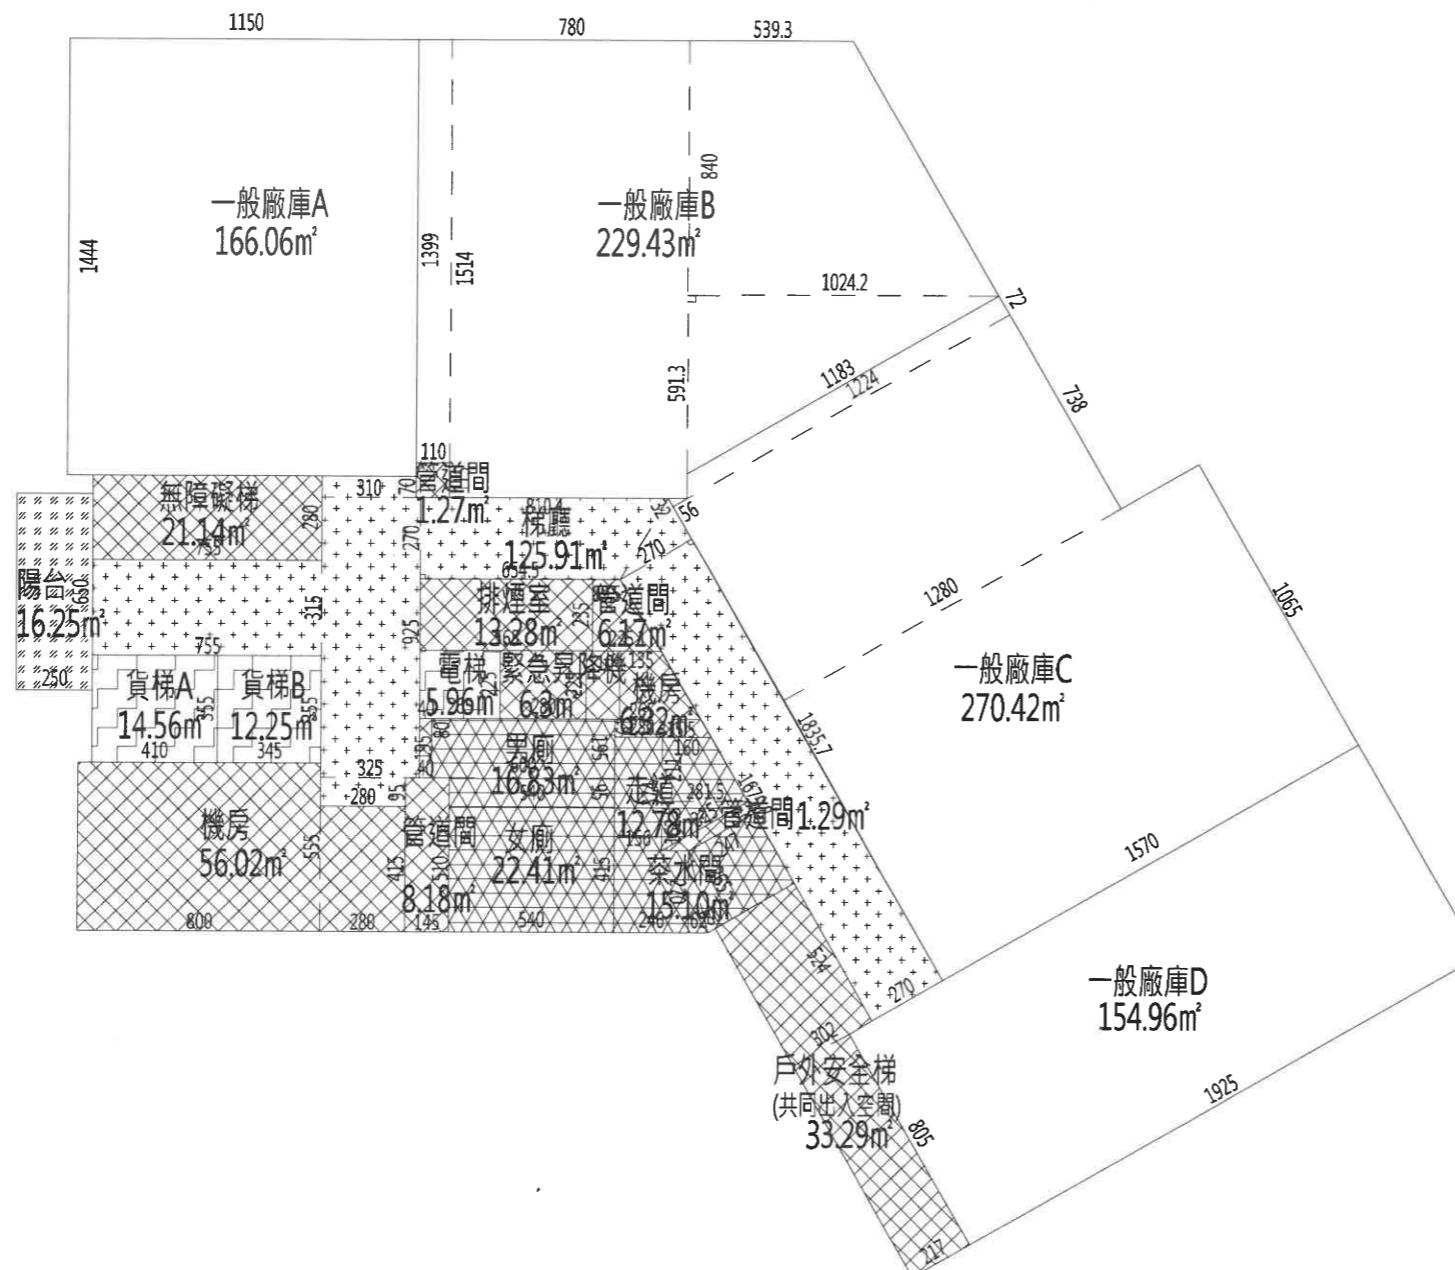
地上二層平面圖(維持原核定)(S : 1/300)
